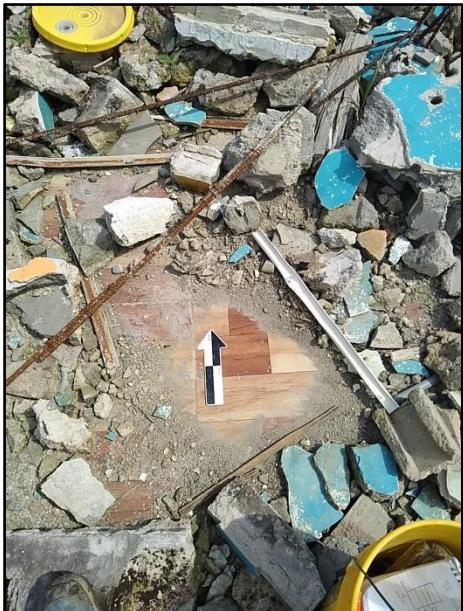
Piso de concreto con baldosa encontrado en el centro de la antigua vivienda.
